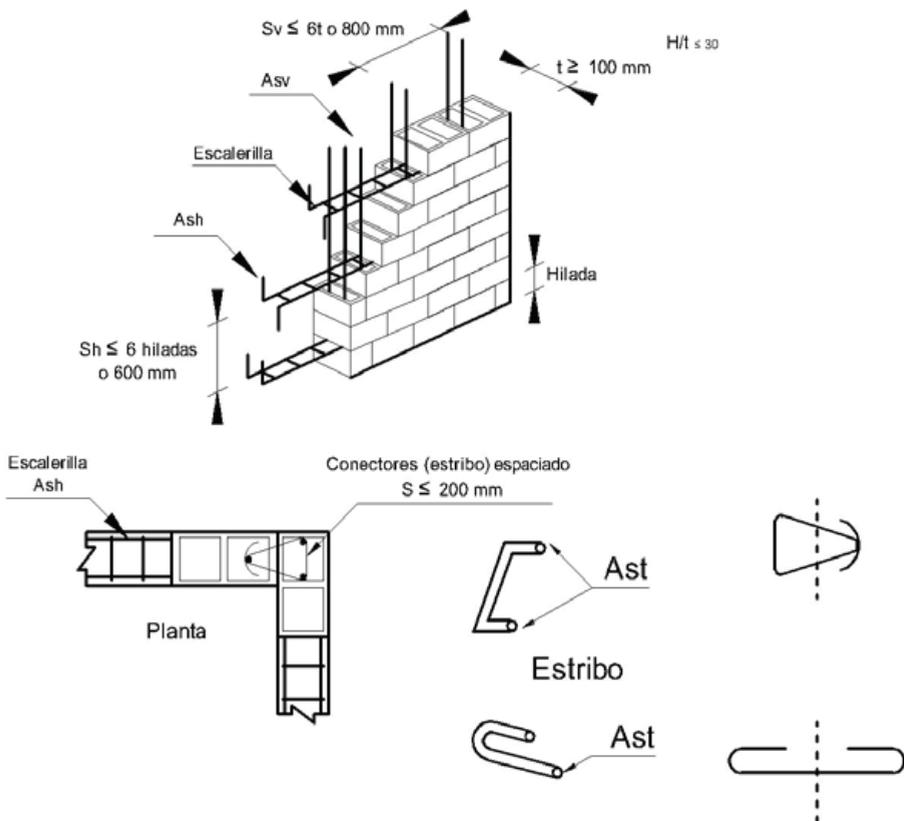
Distribución de refuerzo Vertical y Horizontal. Detalles de encuentro de muros, ubicación de estribos y conectores
